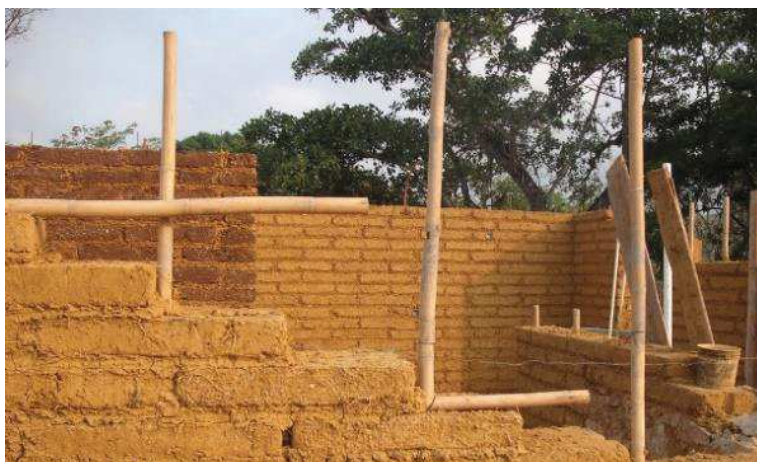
Refuerzos verticales. Fuente: Arturo López.
